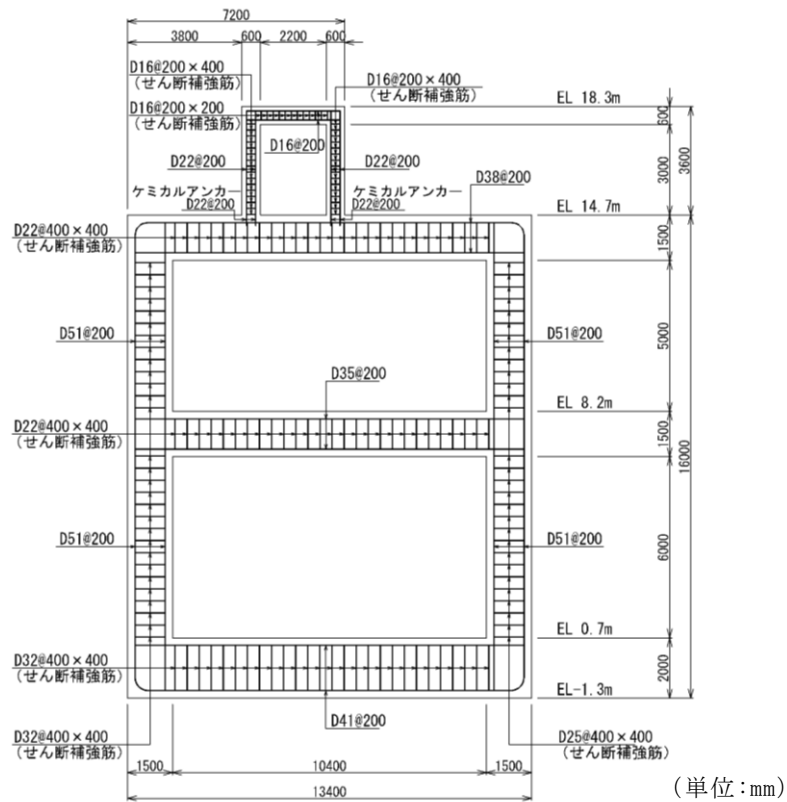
低圧原子炉代替注水ポンプ格納槽 概略配筋図 (A-A 断面)
